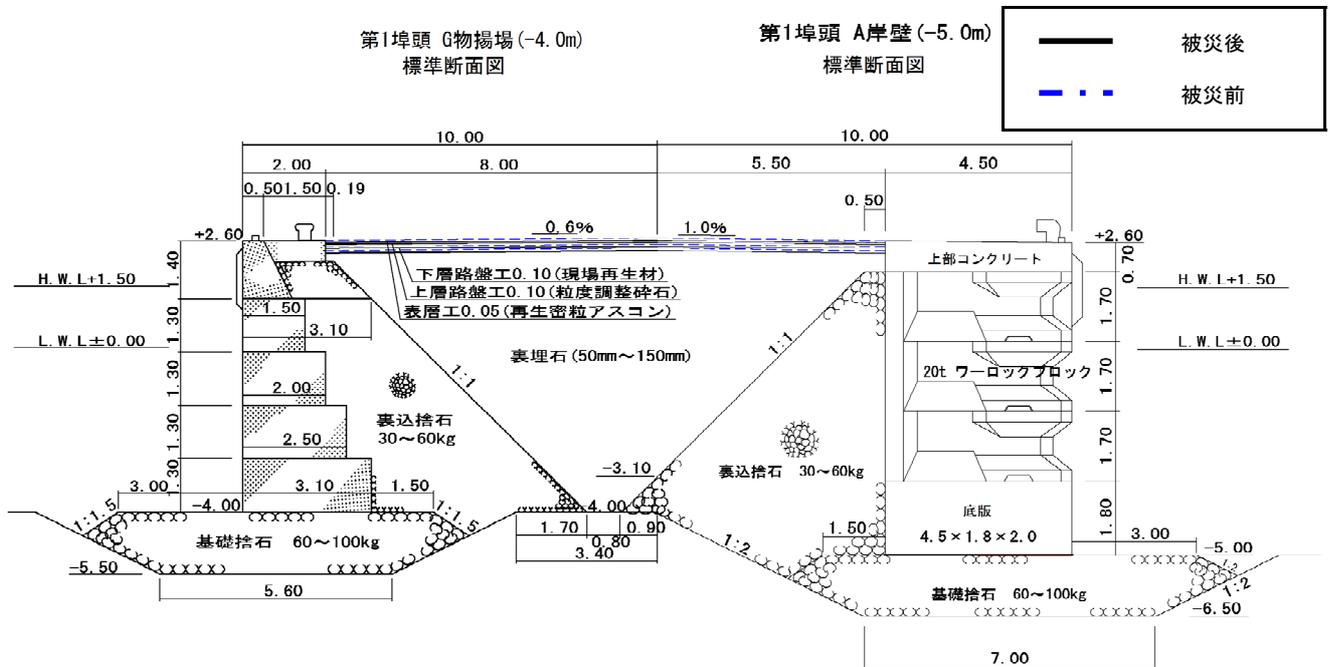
No.28 大洗港区_第1埠頭地区 A岸壁の断面図 (被災後)
